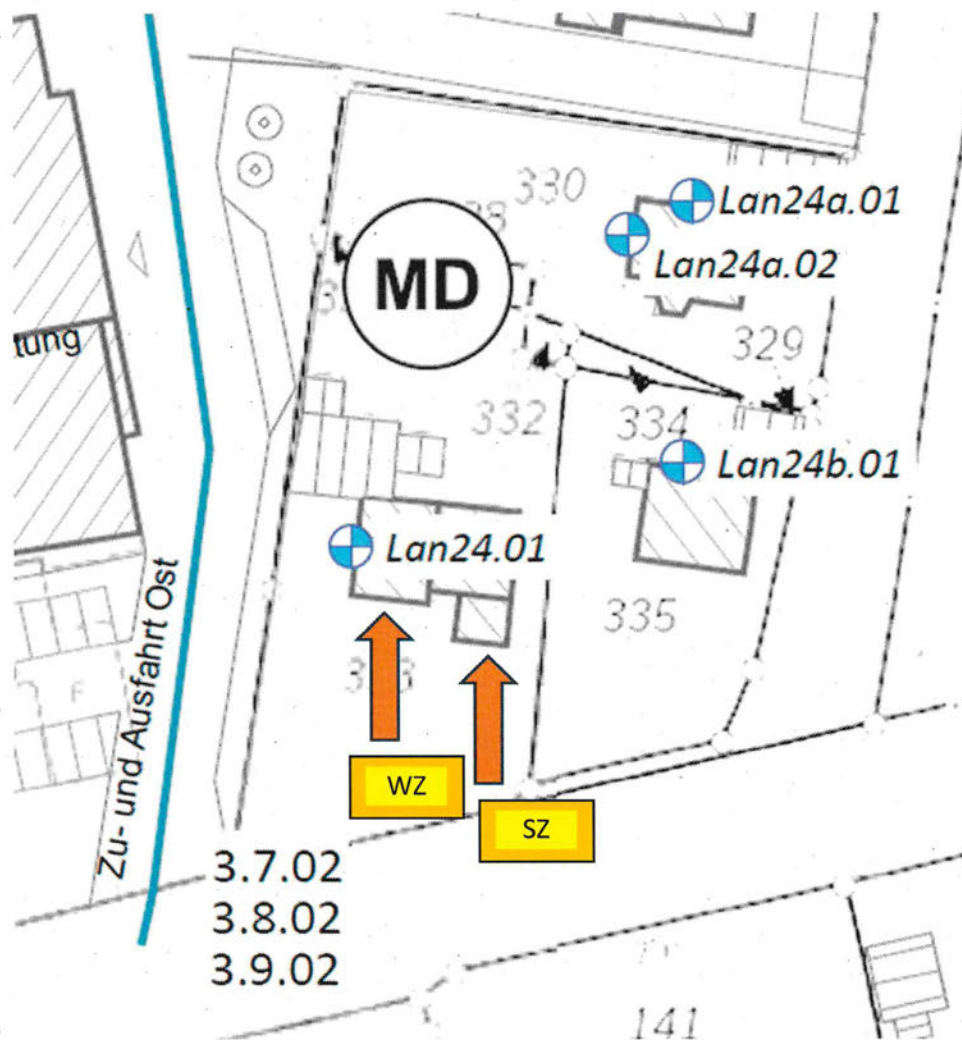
Fassade süd, Schlafzimmer (SZ) und Wohnzimmerlage (WZ)
